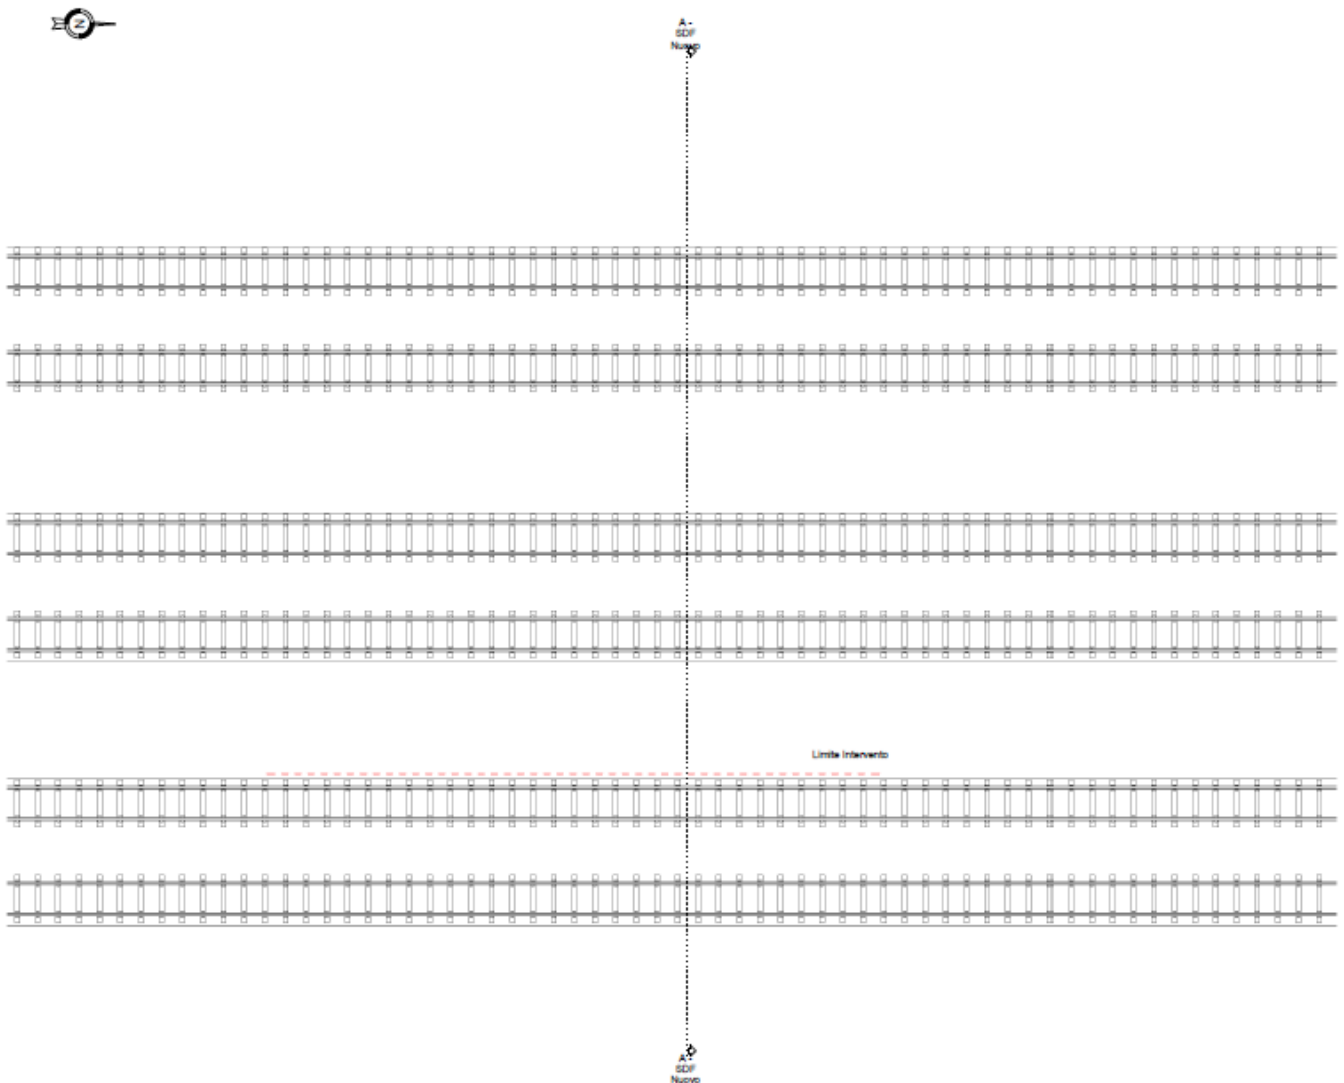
Sottopasso di stazione SL02 – Planimetria dello stato di fatto
